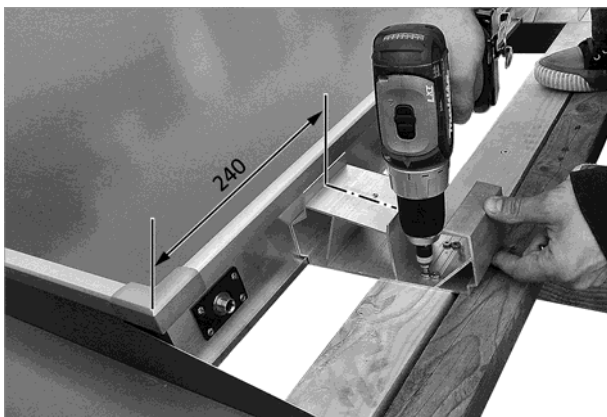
Kollektordistanzstücke links und rechts mit Abstand zur Außenkante anschrauben
